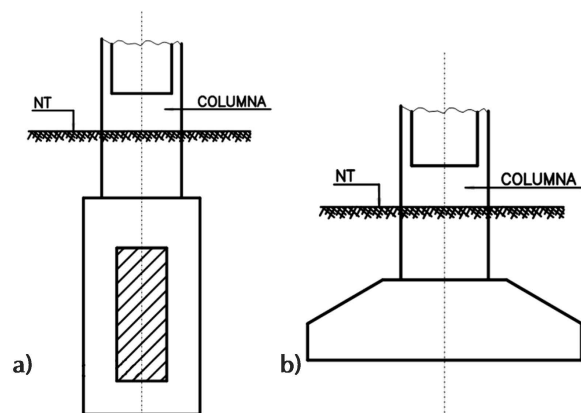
a) Fundaciones tipo pila, b) Fundaciones tipo zapata aislada
